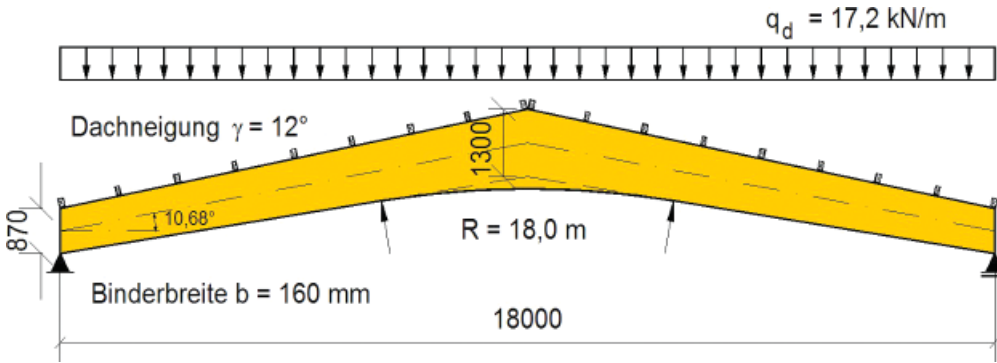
Querschnitt und Belastung eines Hallenbinders (Längen- und Höhenmaße in mm)
